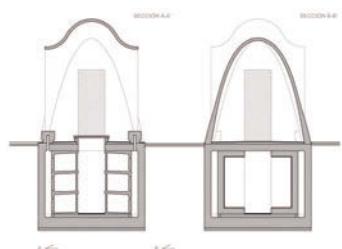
/ Planta de distribución y secciones transversales (Vegas & Miletto).
